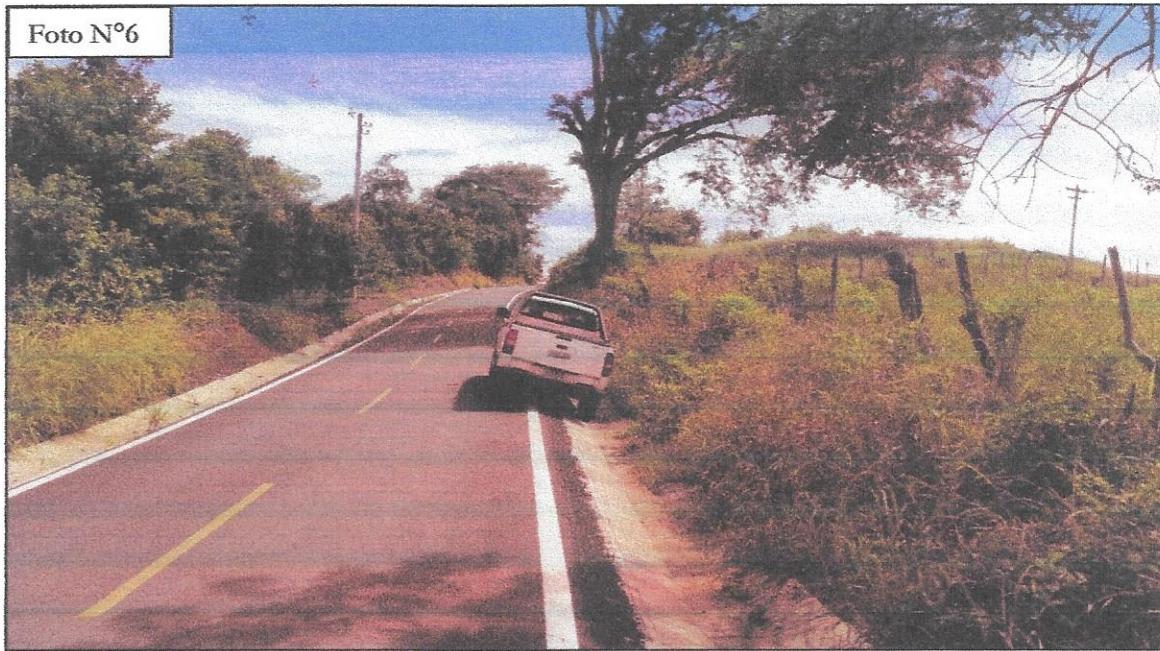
Se observa la calle “Sin Nombre” que da acceso al terreno a desarrollar.
